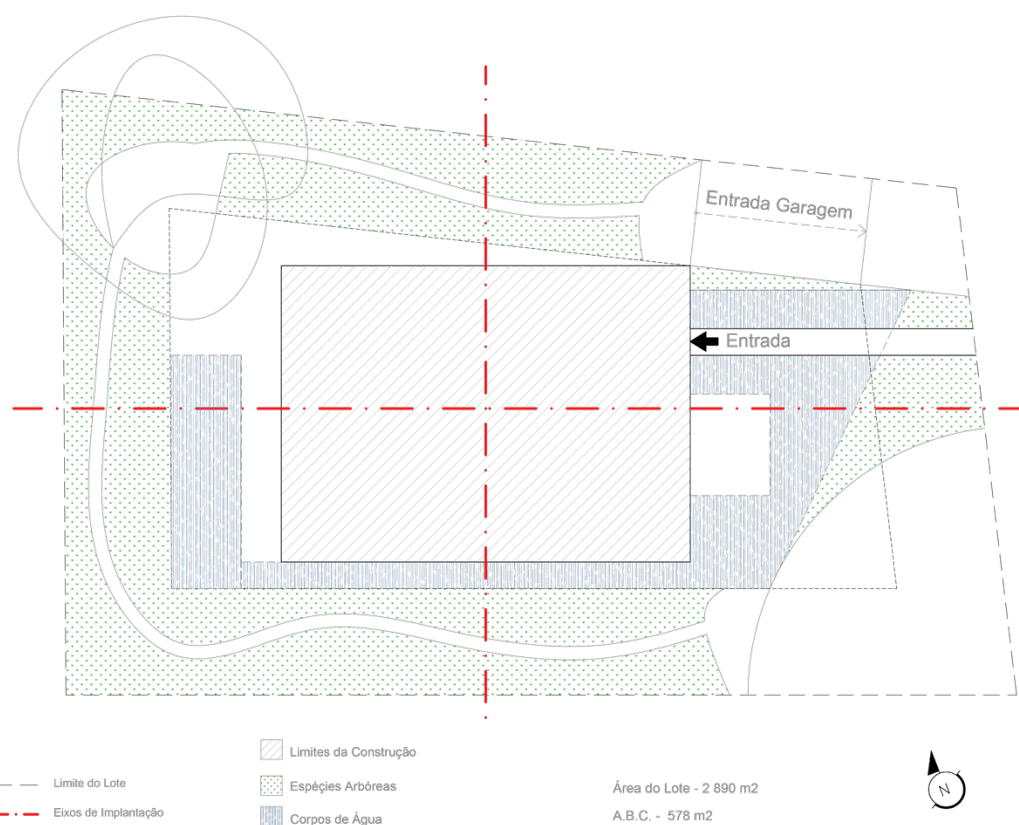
Esquema de implantação para a Proposta (Ilustração do autor)
